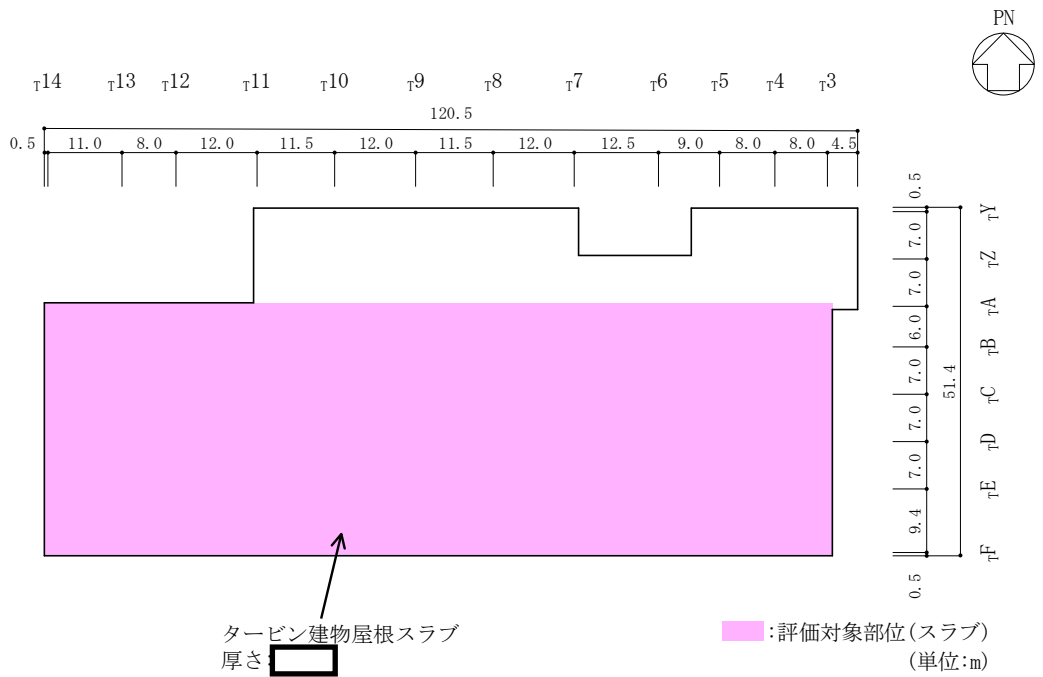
(2) タービン建物の概略平面図 (EL 41.6m)
